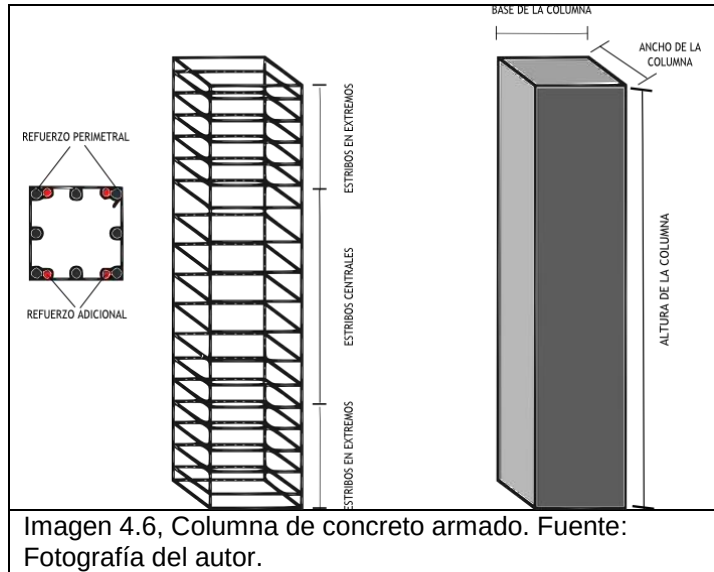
, Columna de concreto armado. Fuente: Fotografía del autor.
